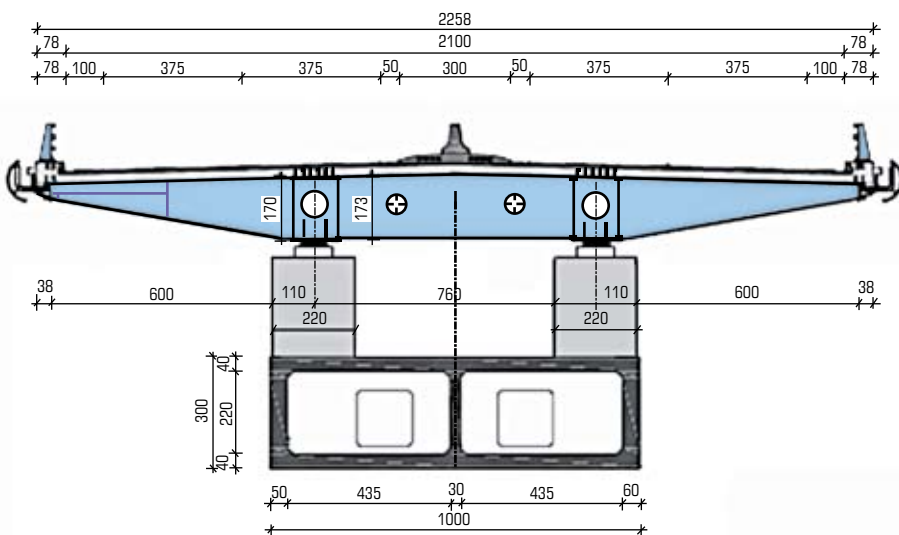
Арка и поперечное сечение пролетного строения моста через реку Крка
